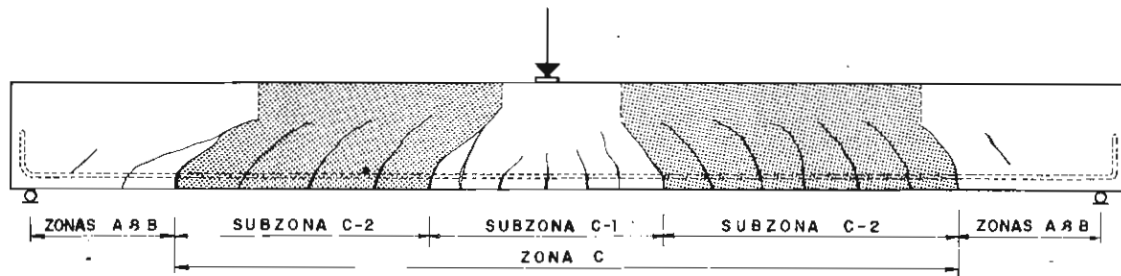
Zonas de diferente comportamiento en piezas de hormigón armado. Sólo se dibujan las fisuras principales. (De un ensayo publicado en la ref. [5]).
